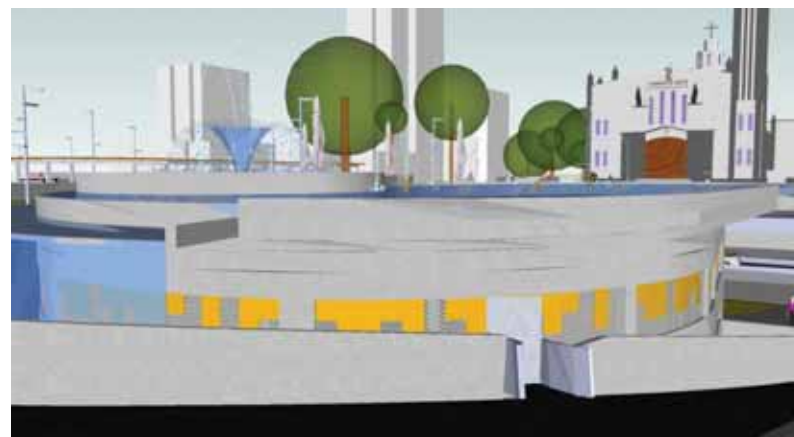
Aberturas por elementos vazados e entrada do pavimento tecnico.
